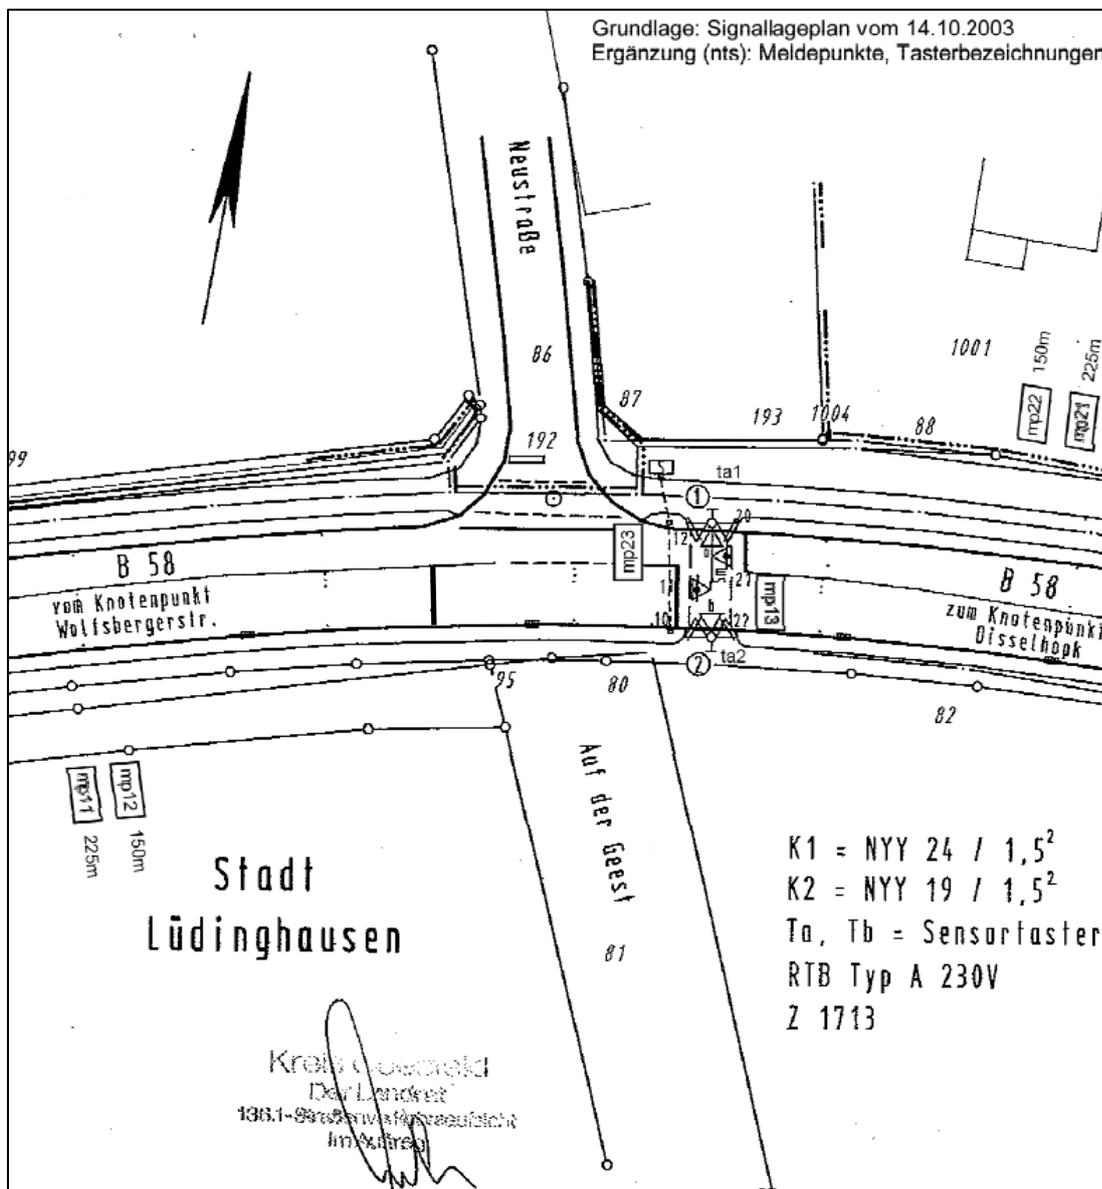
Signallageplan Disselhook (Quelle: Stadt Lüdinghausen)
